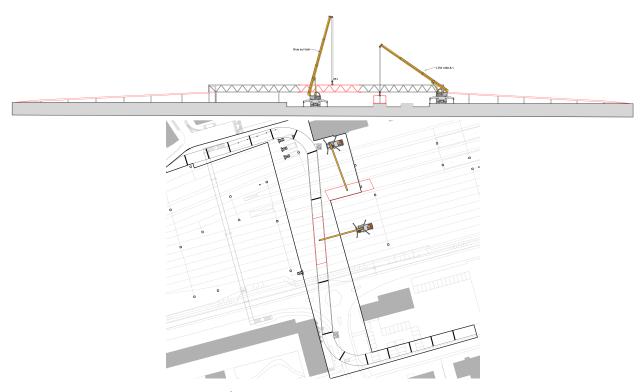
Étape 5 : Montage tronçon 5, bétonnage rampe
